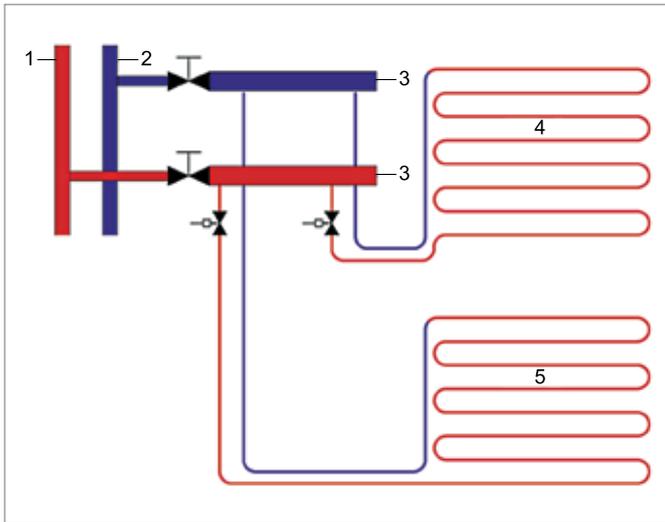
Rappresentazione schematica del collegamento separato di ogni sezione di riscaldamento a parete
